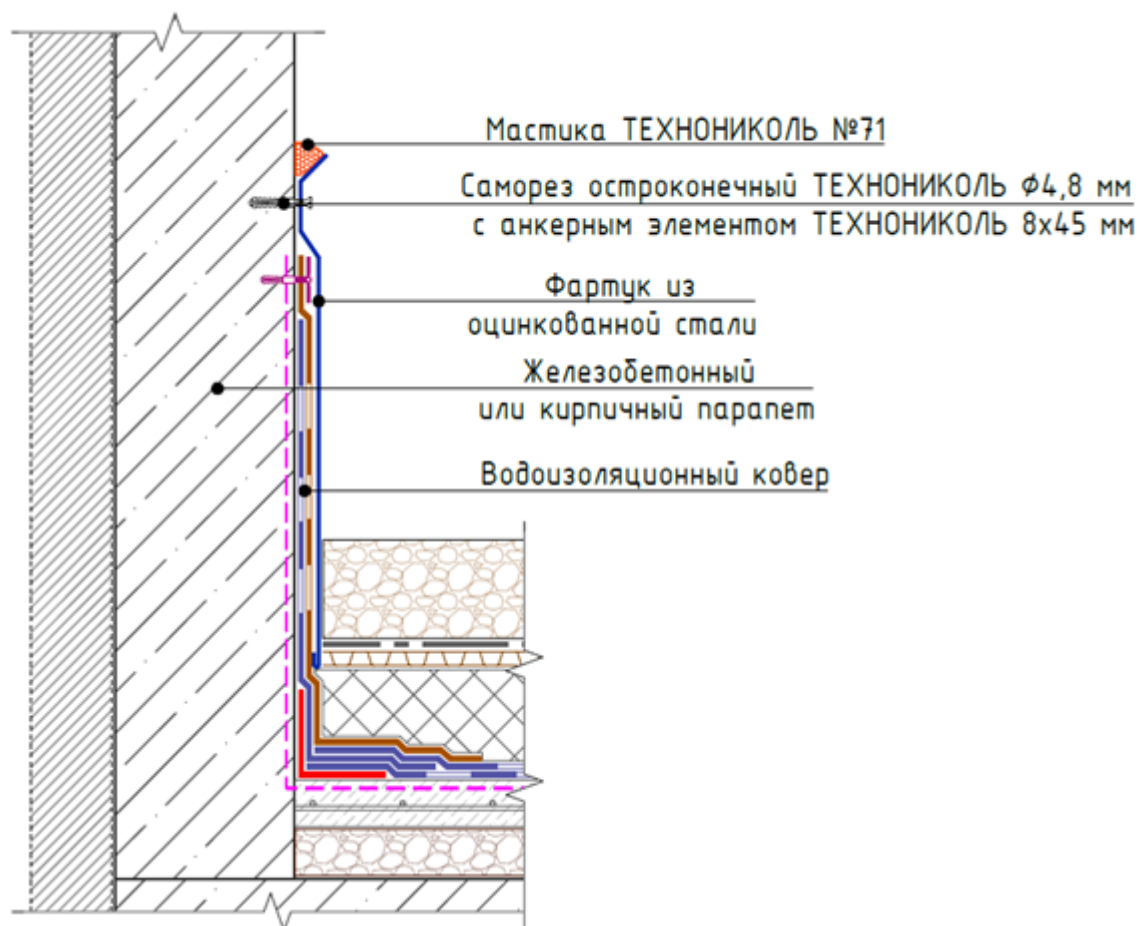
Крепление фартука из оцинкованной стали к железобетонному или кирпичному парапету
